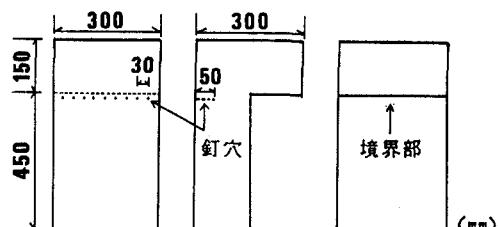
沈みひびわれ発生率およびコンクリートの流動性試験用模擬供試体
